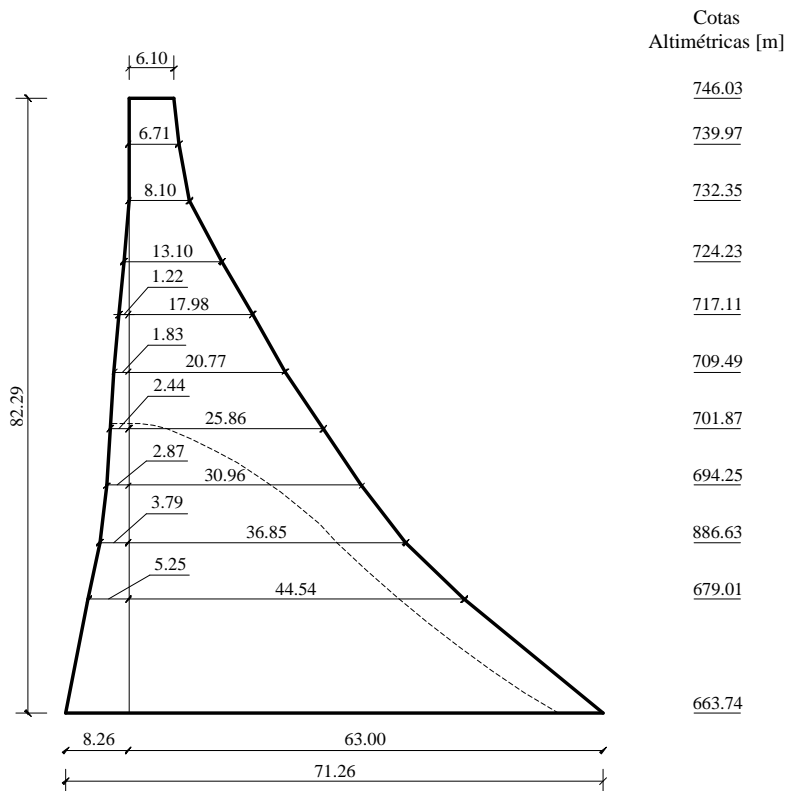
Barragem de Bhandardara – Geometria e localização da fissura (a traço interrompido)
